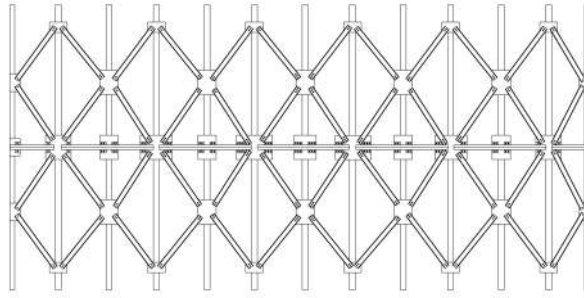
Vista en planta inferior. Tirantes diagonales y longitudinales. Puente L=18 m. Elaboración propia
